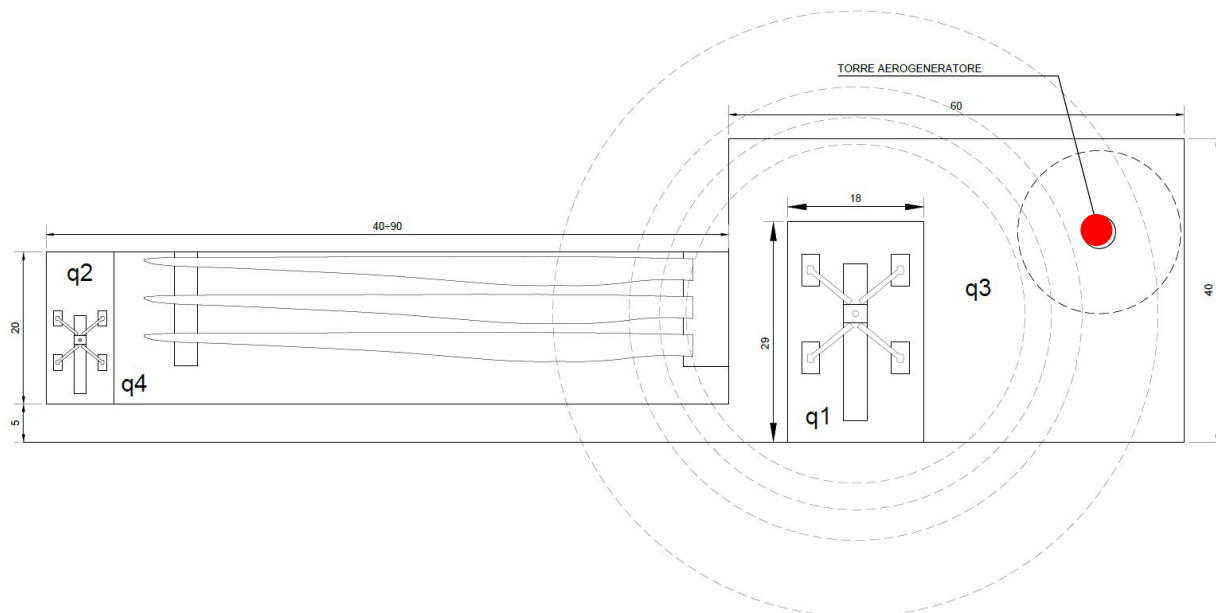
Planimetria tipo di pista e piazzale di esercizio di una turbina (in rosso). La dimensione e posizione relativa dell'area di stoccaggio possono variare come da layout di cantiere.
